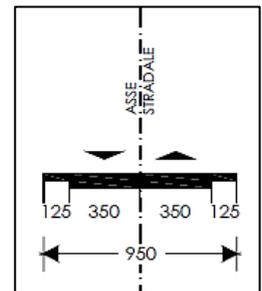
Adeguamento SS125 - Sezione tipo C2
